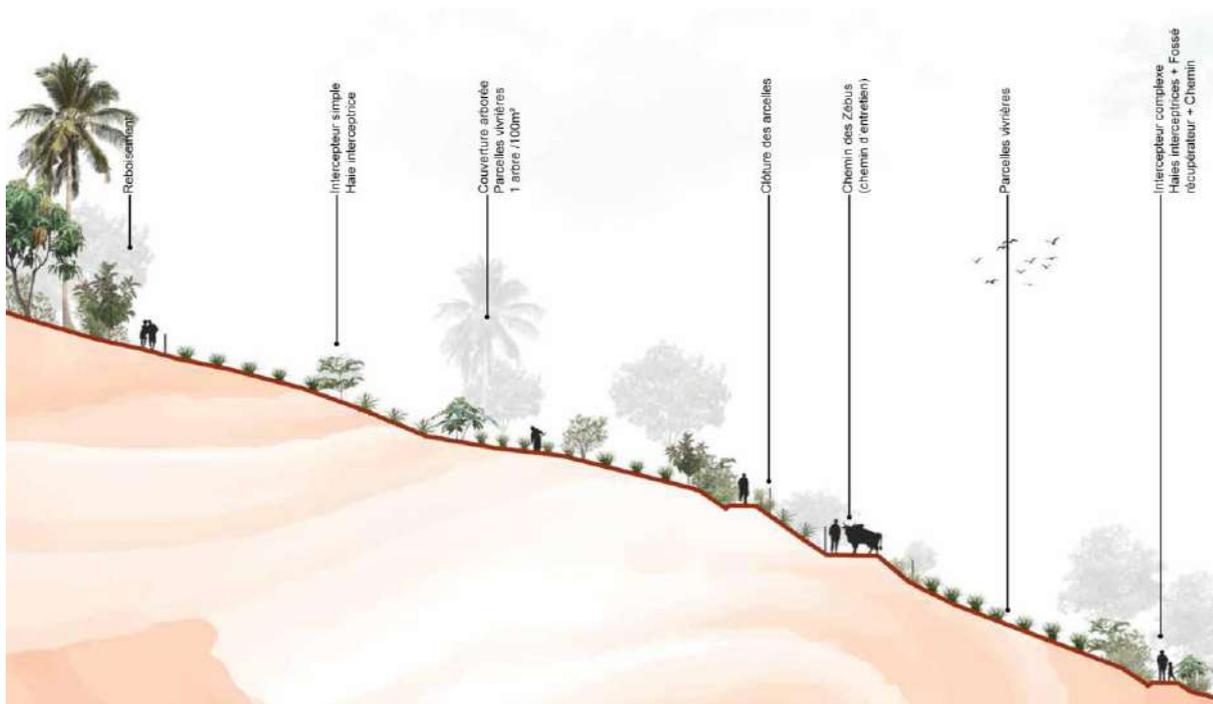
Coupe de principe des aménagements du coteau (AVP)
